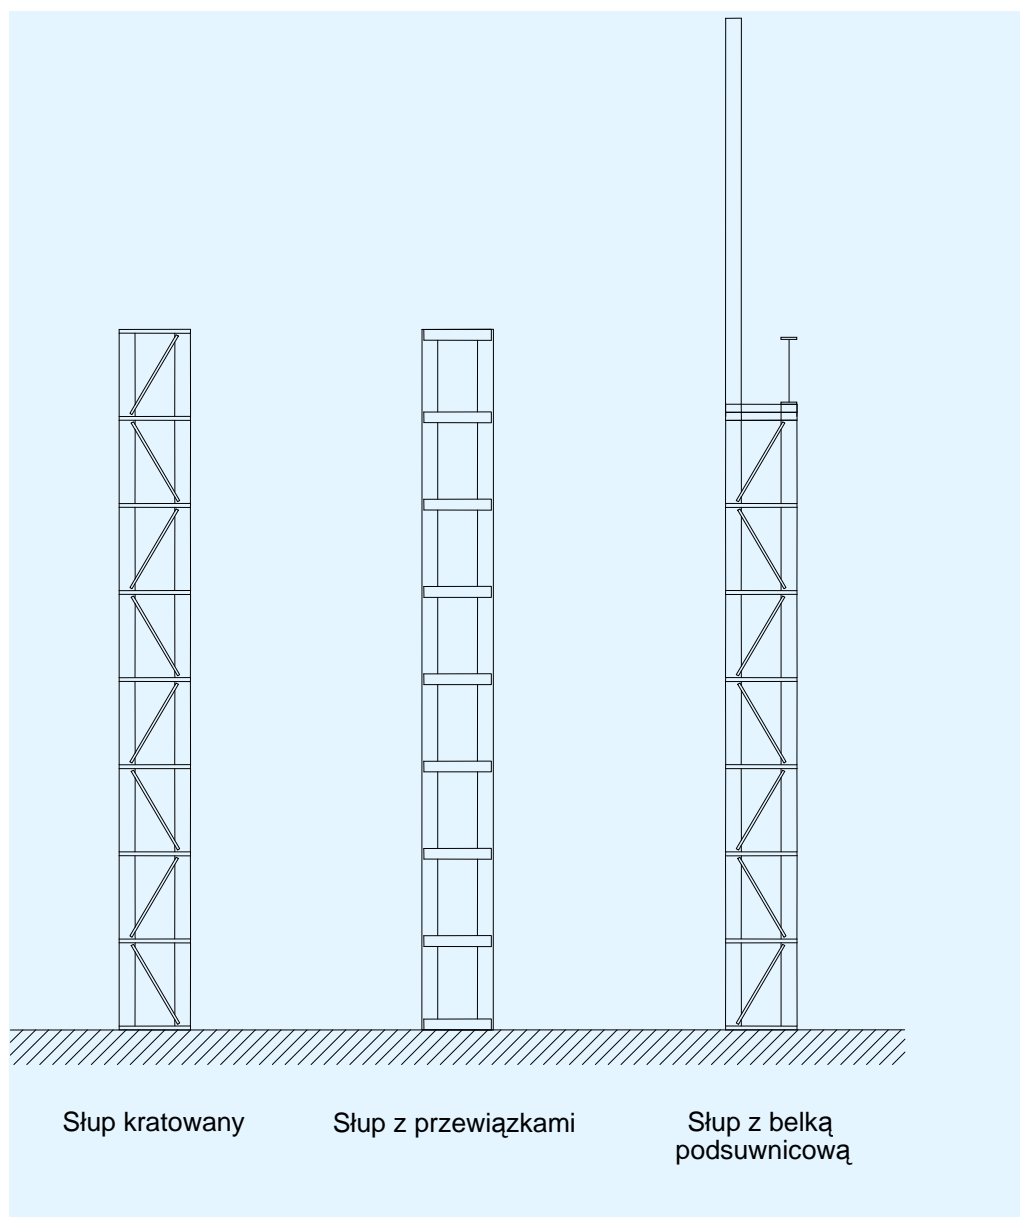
Przekroje poprzeczne słupów złożonych
